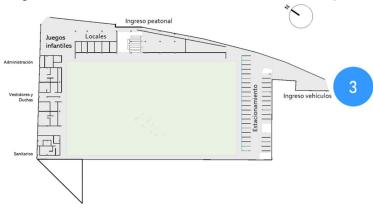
Planta de Primera Aproximación, Fuente: Elaboración Propia
